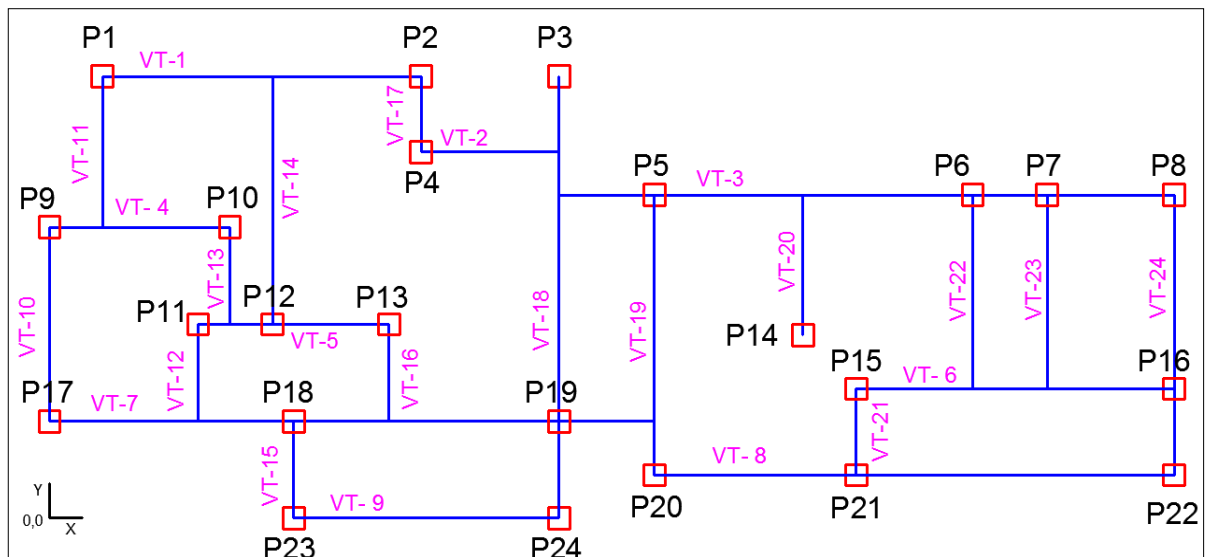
Planta baixa simplificada das vigas de transição do edifício Niterói.
